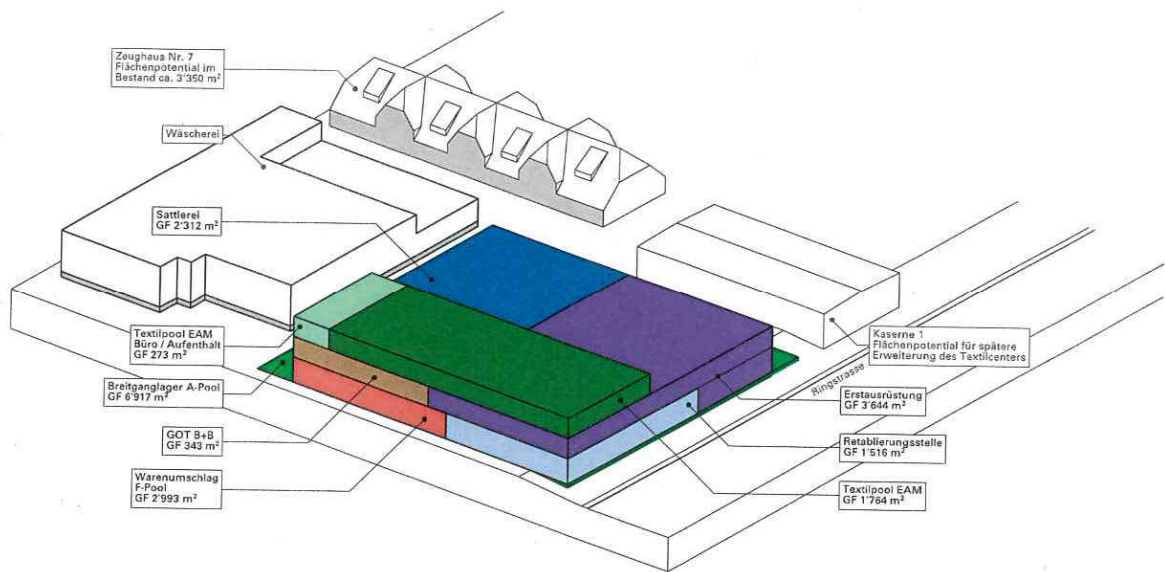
unabhängiger Neubau mit konventionellem Breitganglager im Untergeschoss
